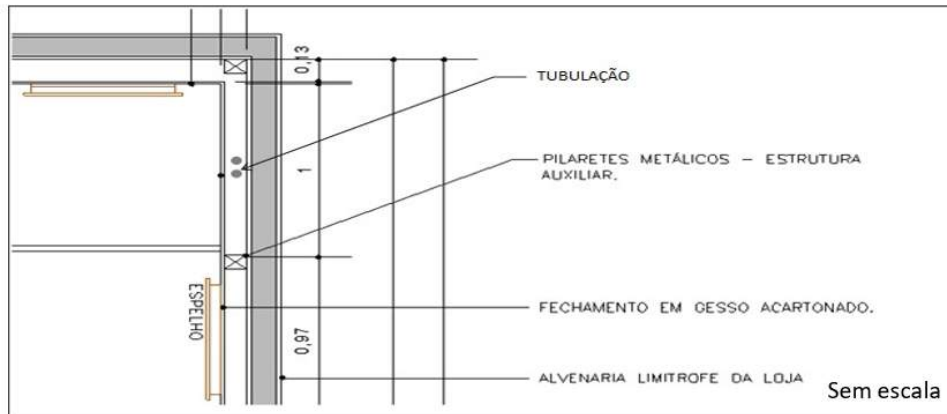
Exemplo da estrutura auxiliar e fechamento em drywall.
